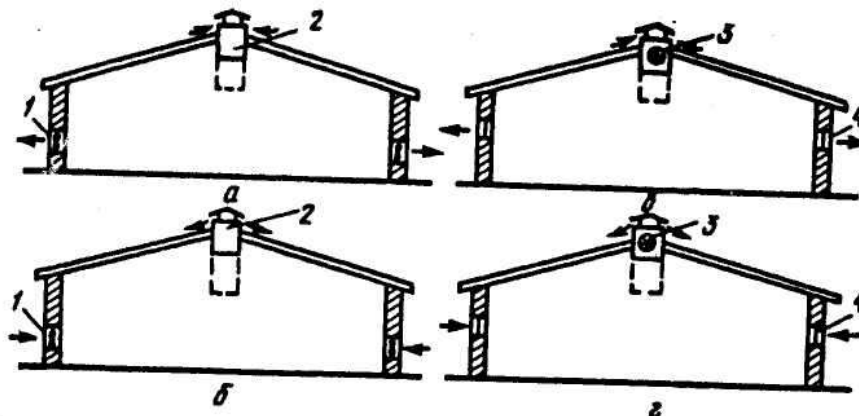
Основные типы летней вентиляции животноводческих помещений: а - вытяжная с настенными вентиляторами; б - приточная с настенными вентиляторами; в - приточная с крышными вентиляторами; г - вытяжная с крышными вентиляторами;
